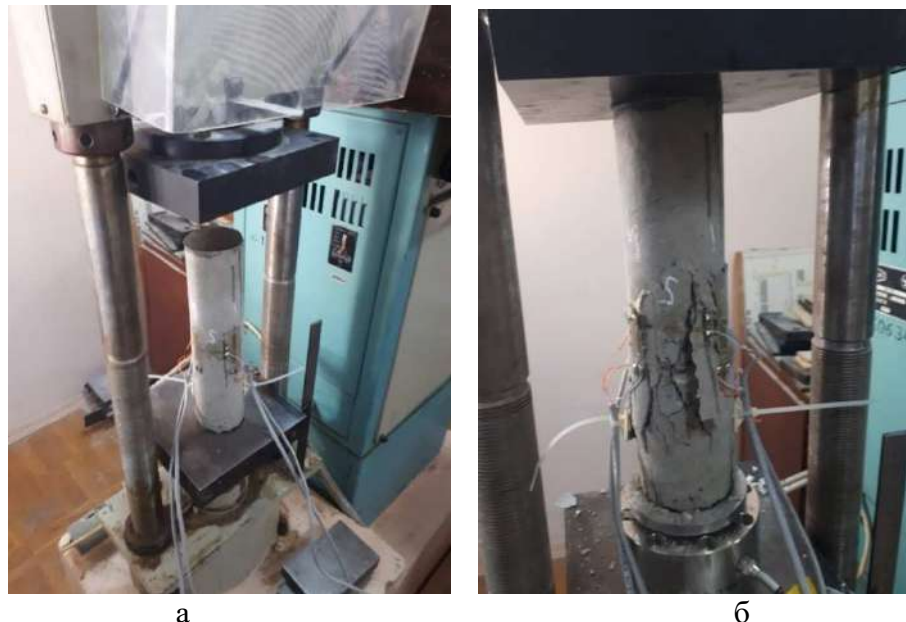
Установка для тензометрических испытания бетона: а – бетонный образец до испытаний; б – разрушенный бетонный образец после испытаний
